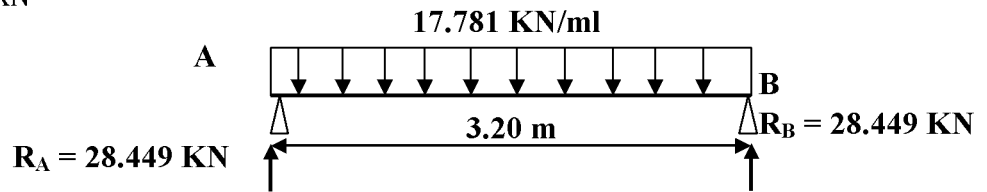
Schéma statique de la poutre palière à l'ELU
